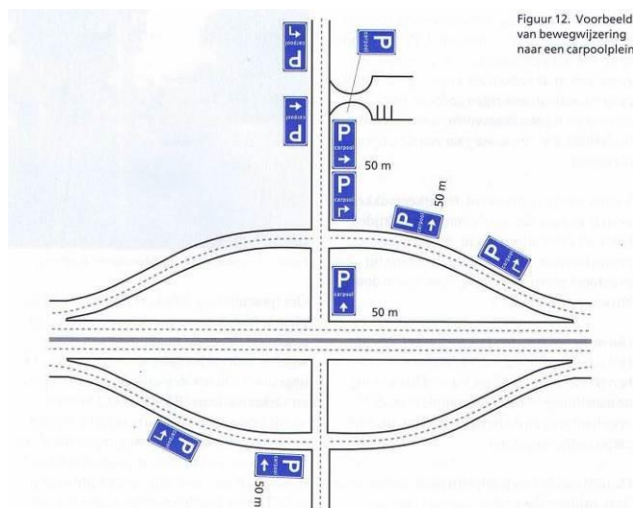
Plan de signalisation d'un parking de covoiturage aux Pays-Bas (Source : CROW)
